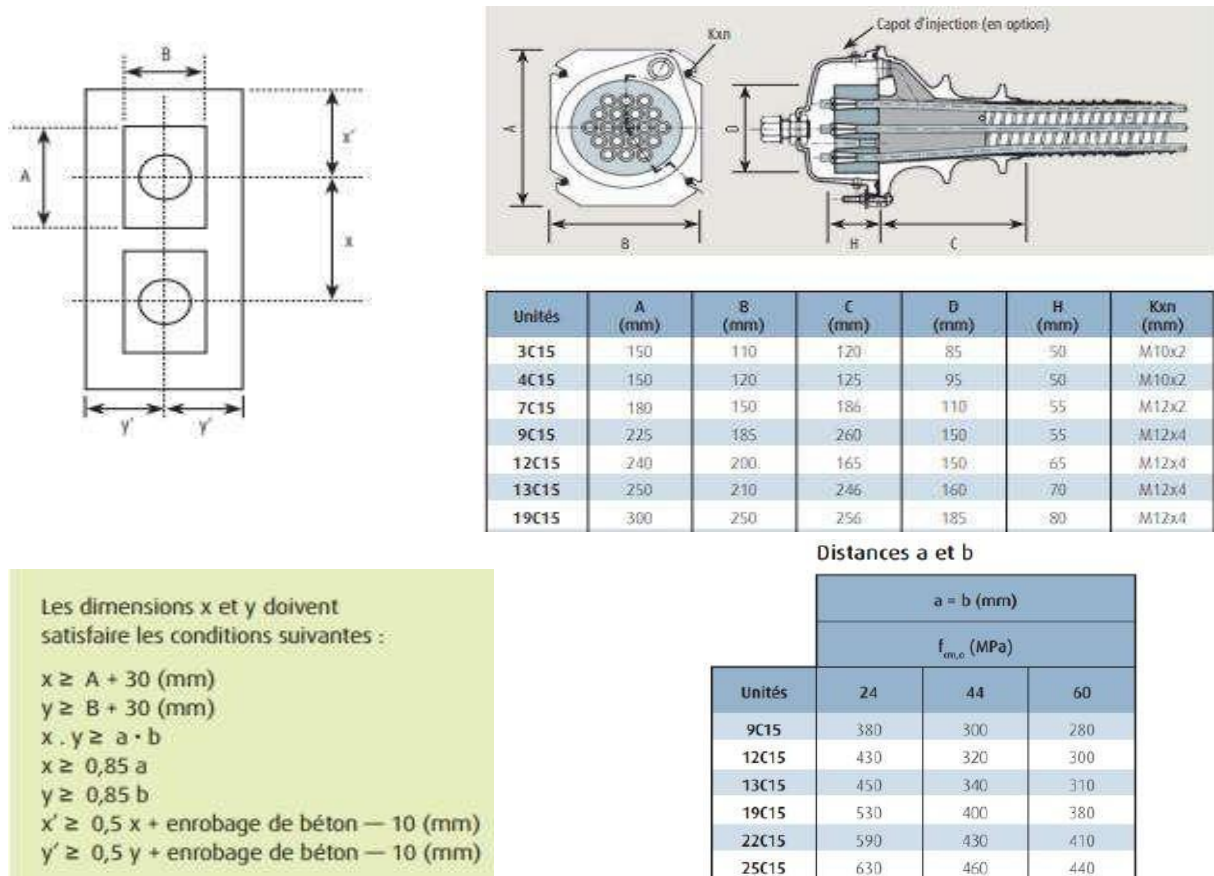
Dimensions et dispositions des plaques d'ancrage.
